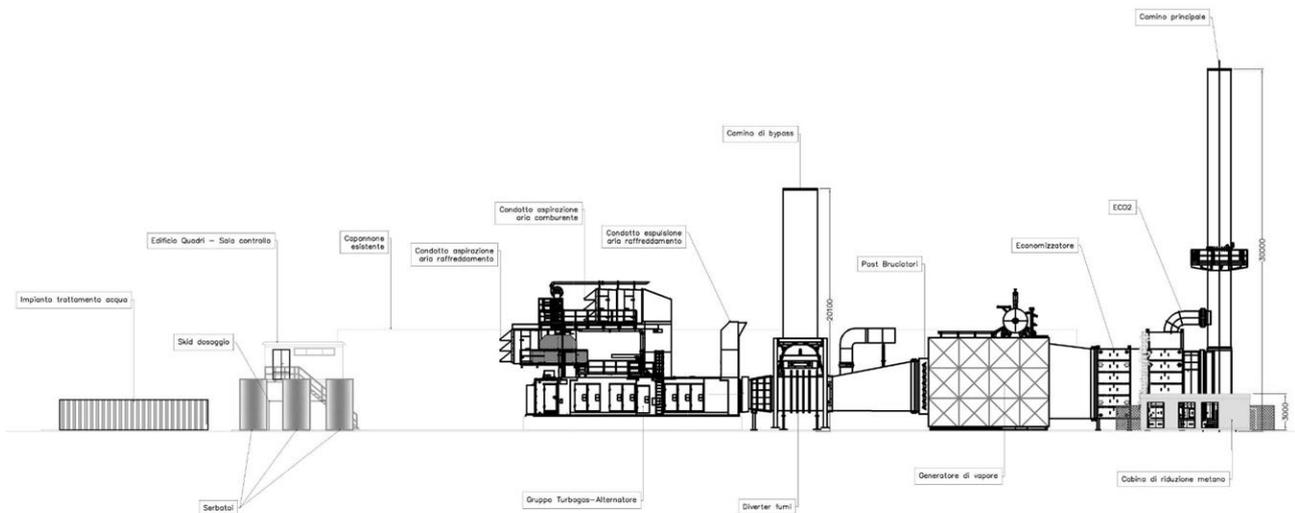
Prospetto della nuova centrale di cogenerazione (vista da Sud)
